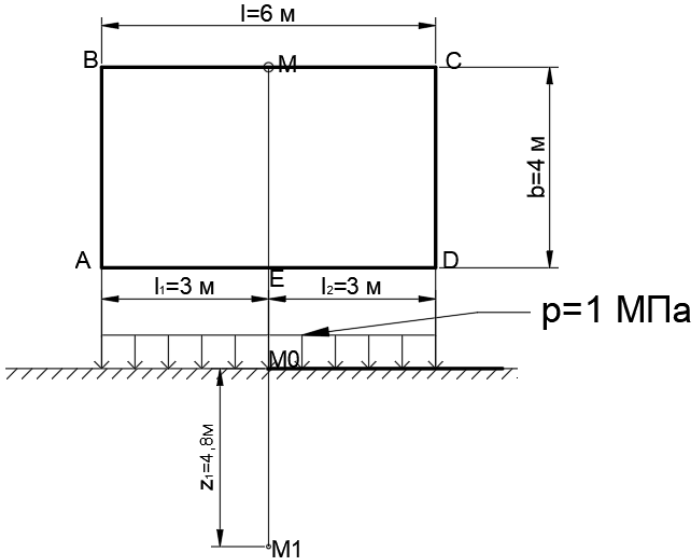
Схема розташування точки M за дії рівномірно розподіленого навантаження на поверхню прямокутного фундаменту, що знаходиться посередині на краю фундаменту.
